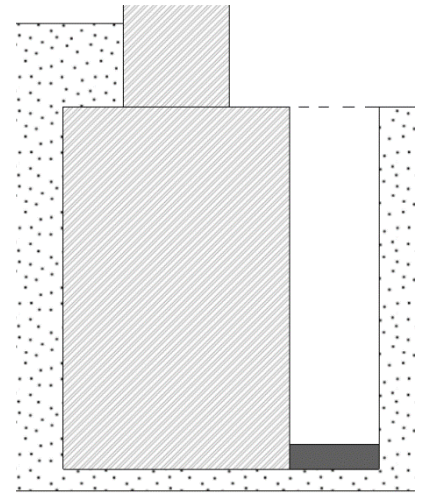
El emplantillado deberá ser nivelado y vibrado, el espesor está sujeto a proyecto. Fuente: Elaboración propia.
